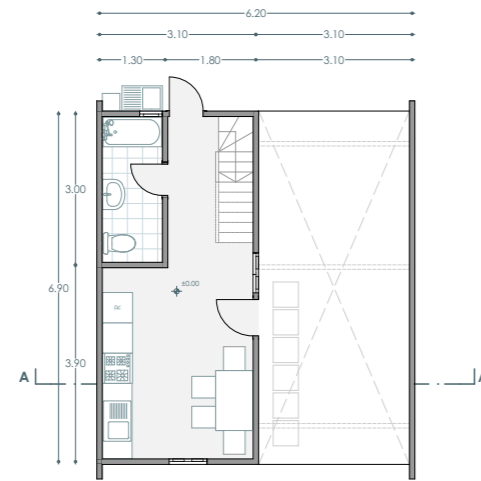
Planta baja Villa Verde. Fuente: Autores, 2023
